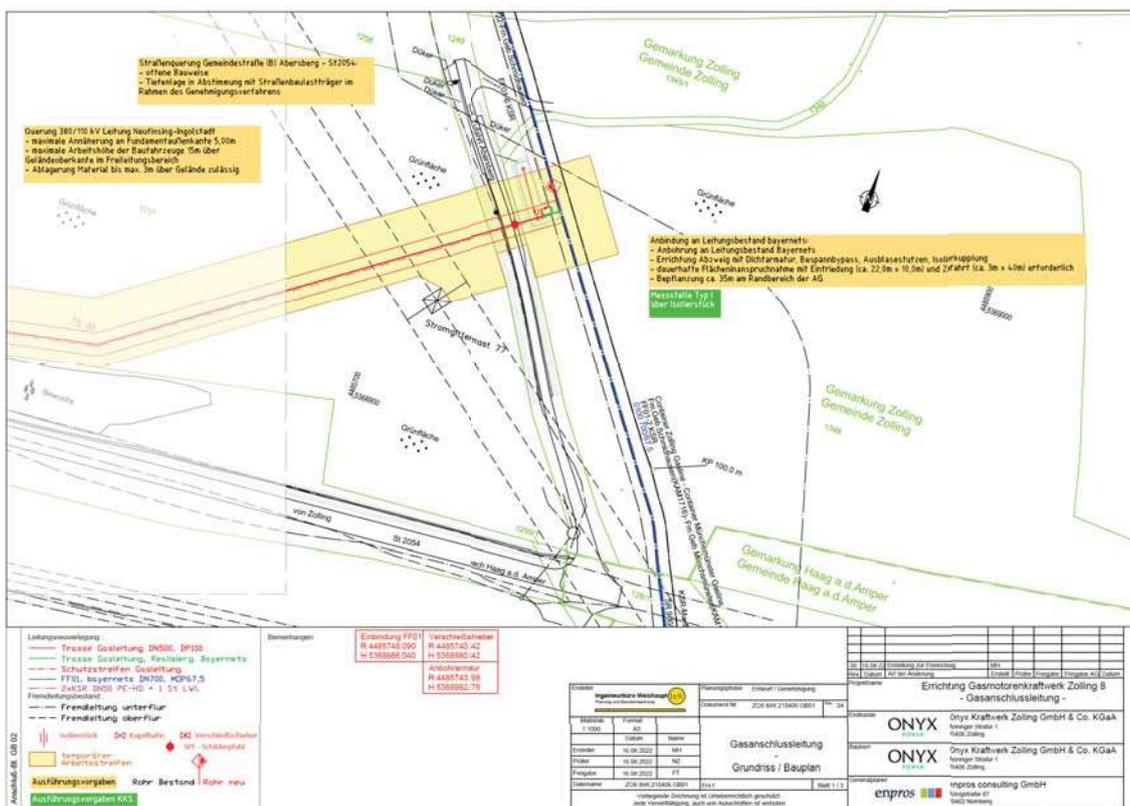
Gasanschlussleitung – Grundrissbauplan Teil 1 [IBW 2023]
